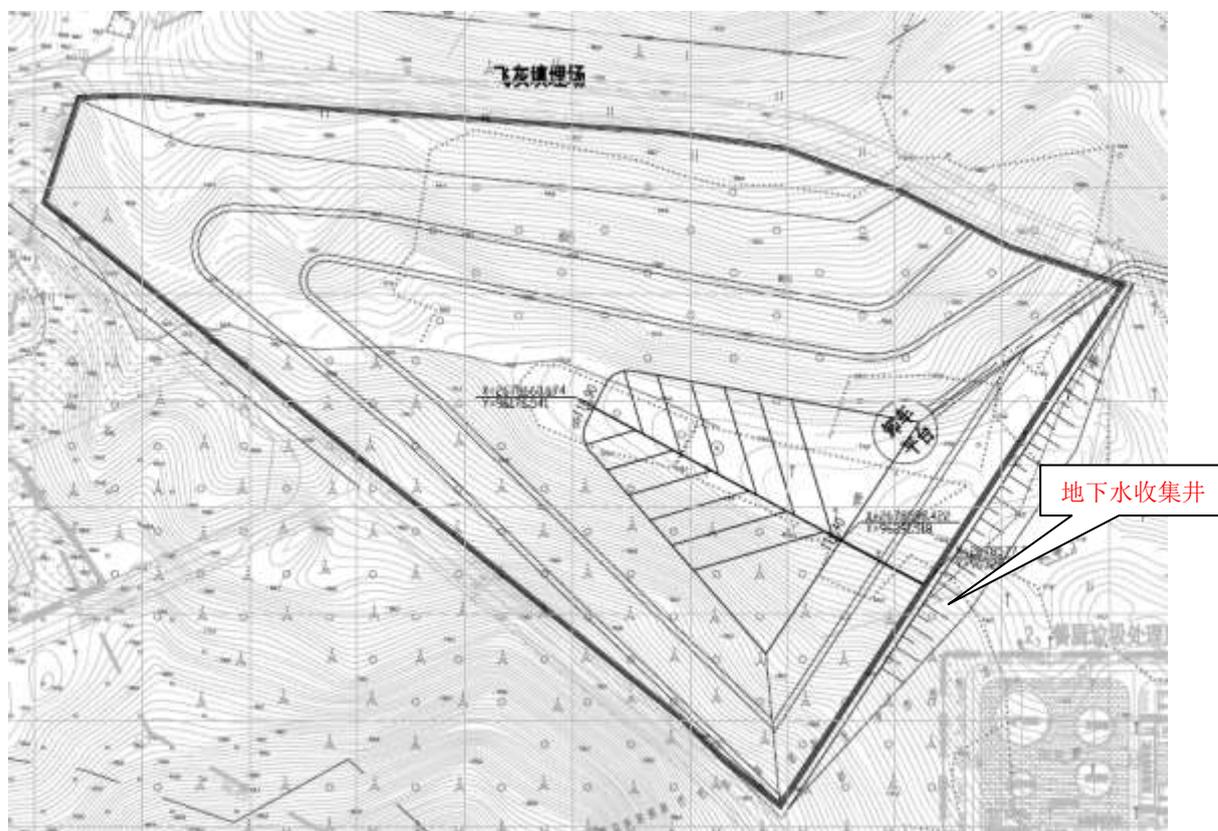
飞灰填埋区地下水导排系统平面布置图
